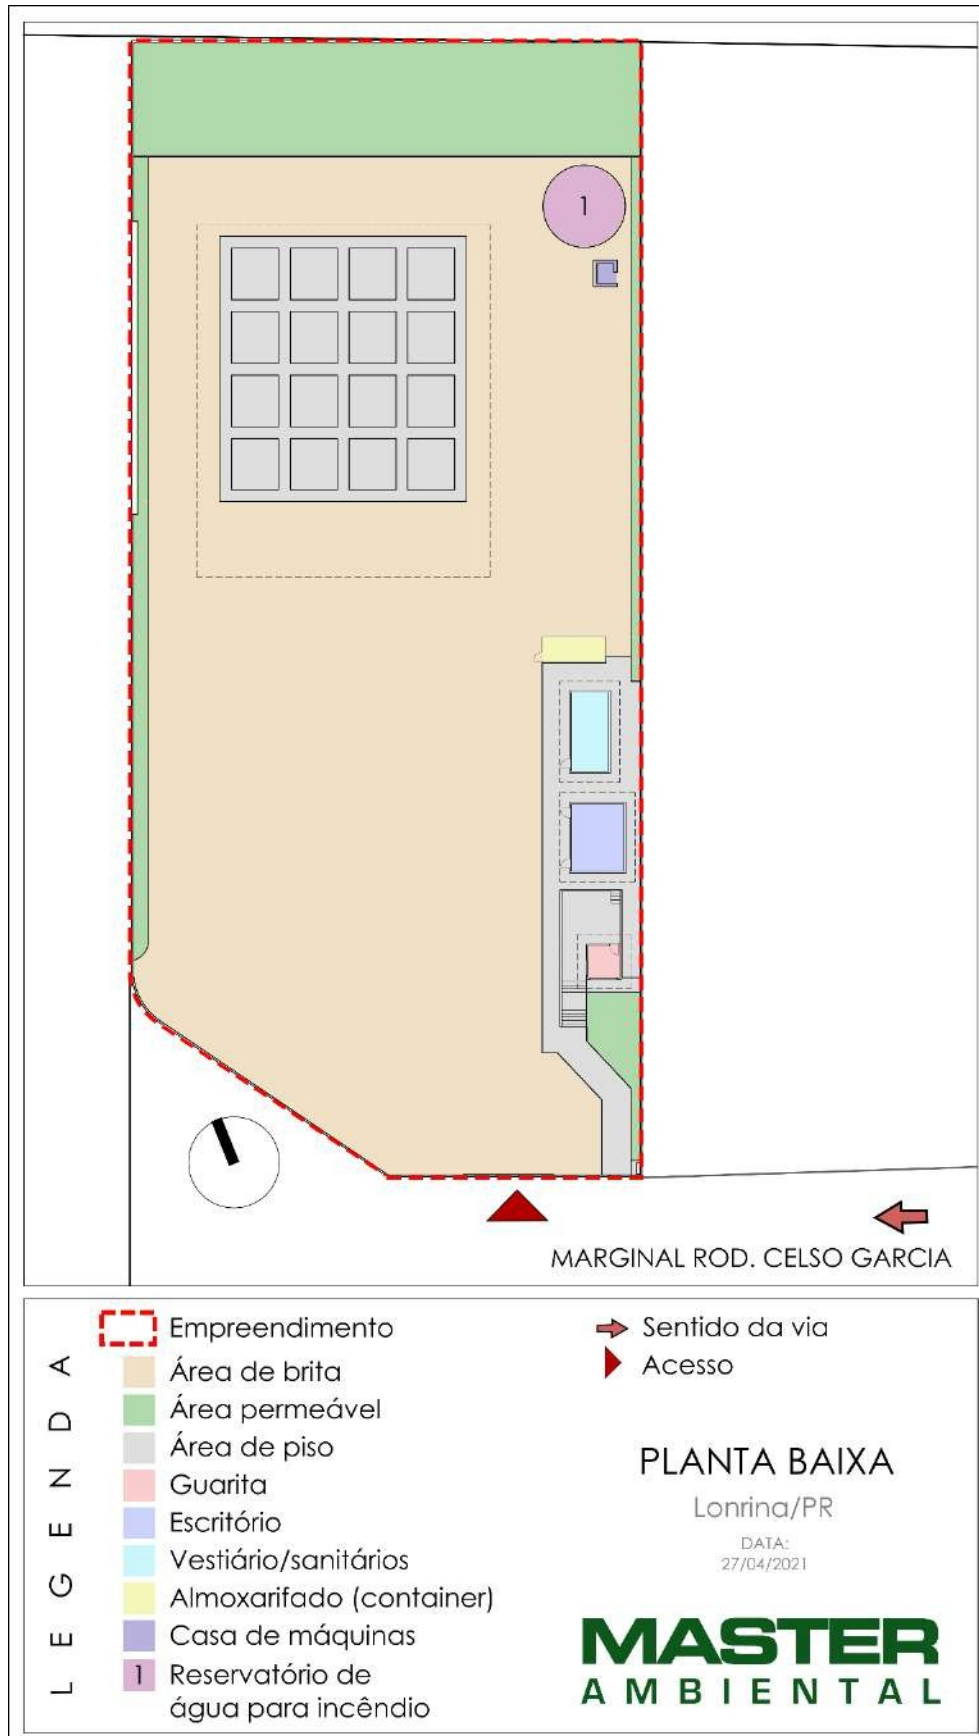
Planta Baixa. Fonte: Projeto Arquitetônico. Adaptação: Master Ambiental, 2021.
